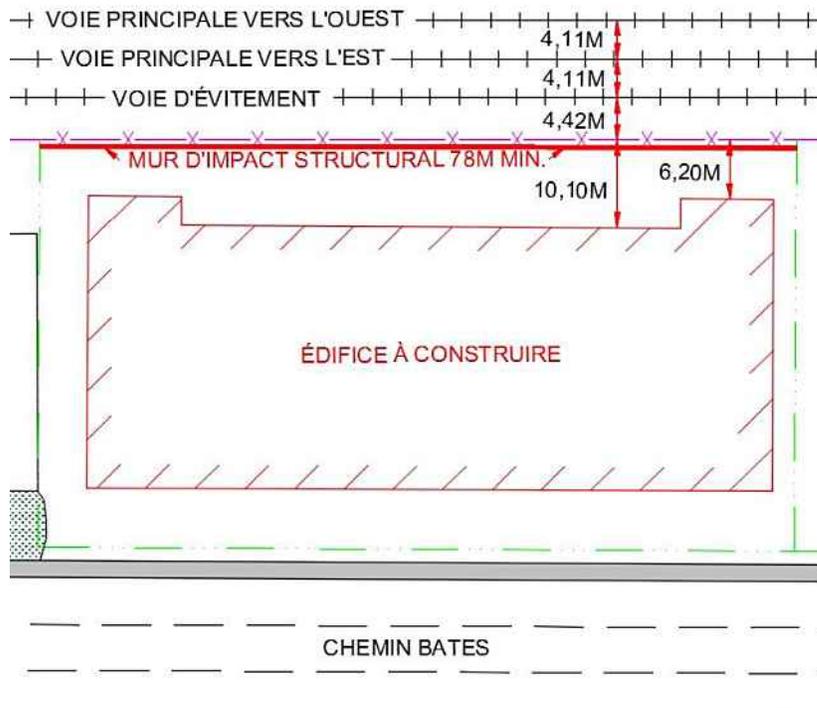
Plan d'ensemble du site proposé au PM 48.71 ADIR.
